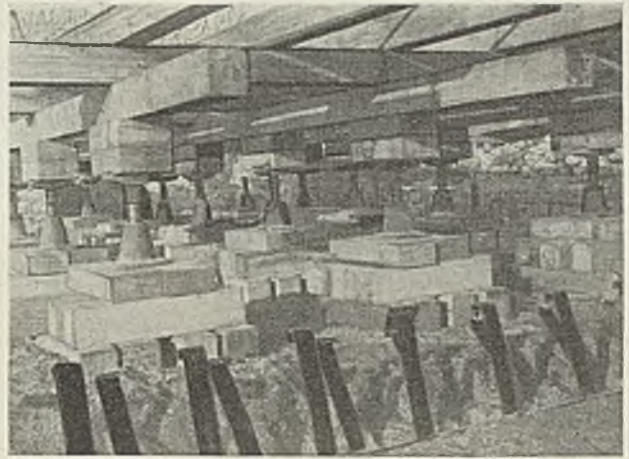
Abstützen der Senkkastendecke im Innern und Ausrüstung mit Spindeln vor dem Einschalen und Betonieren. Im Vordergrund Teile der Senkkastenschneide.
